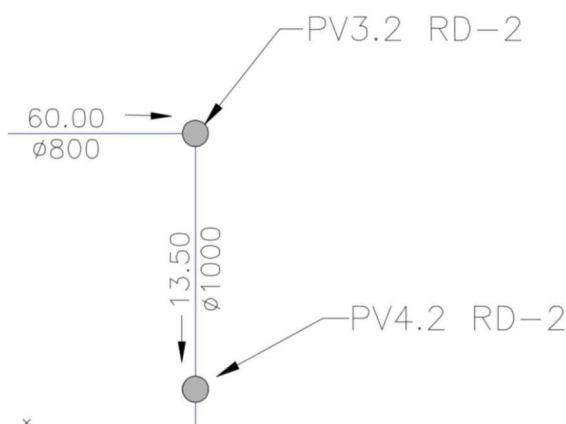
Representação esquemática de um poço de visita – PV na planta geral.
